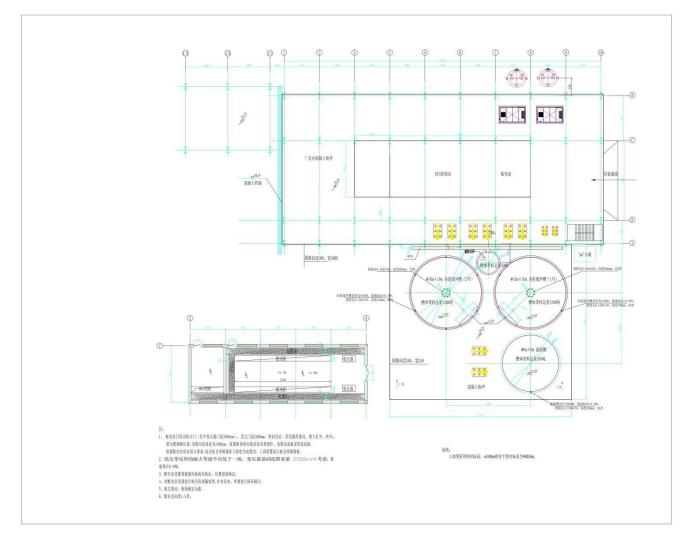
(1) 本项赤泥堆场压滤车间一层平面布置图
